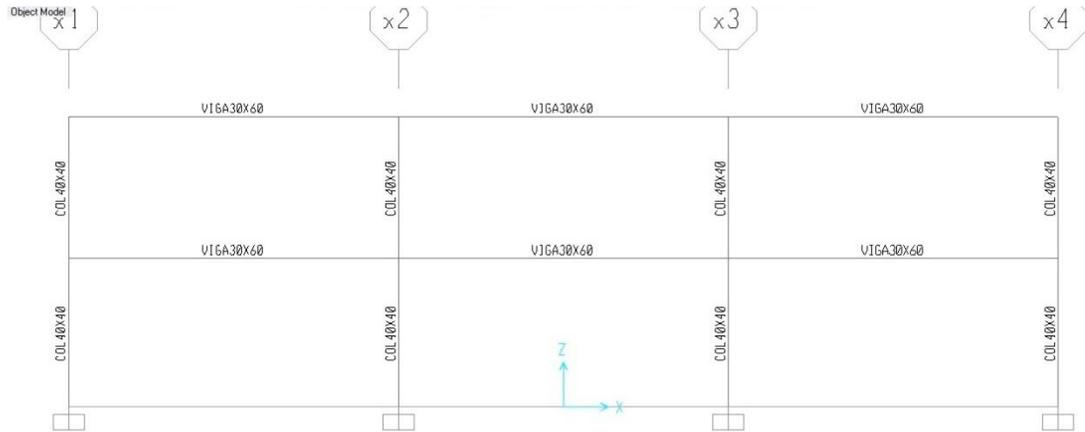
Secciones de Elementos Estructurales de un pórtico.
